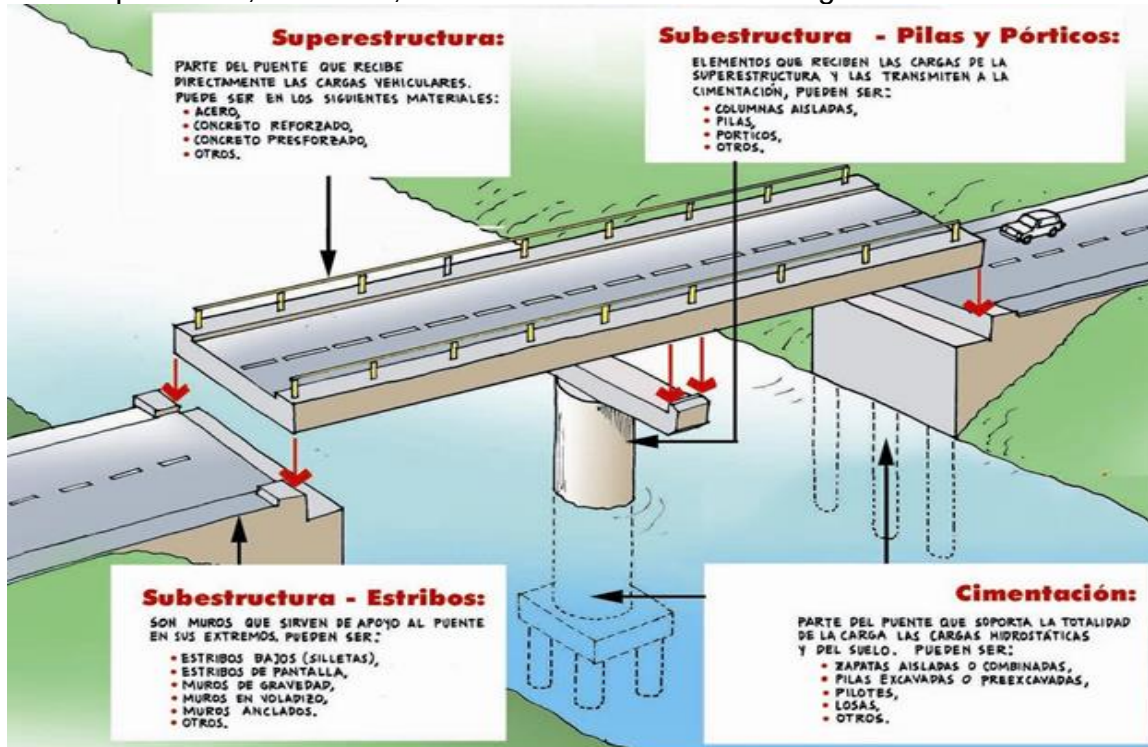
Partes de un puente en concreto simplemente apoyado
